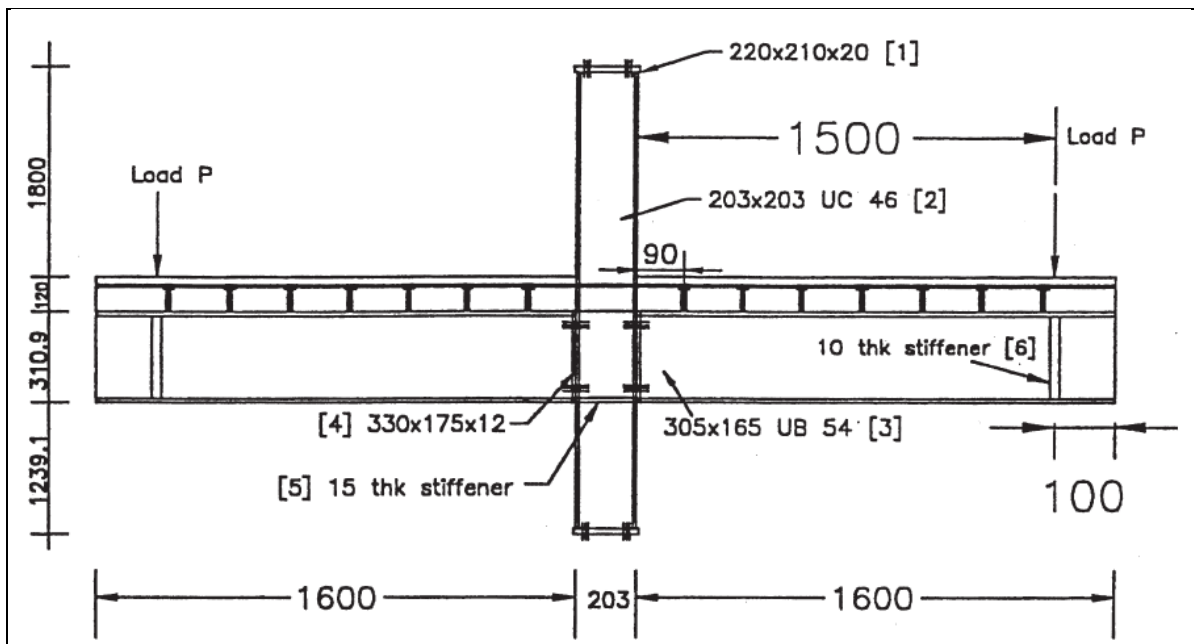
Assemblage mixte (poutre-poteau) par platine d'extrémité boulonnée
